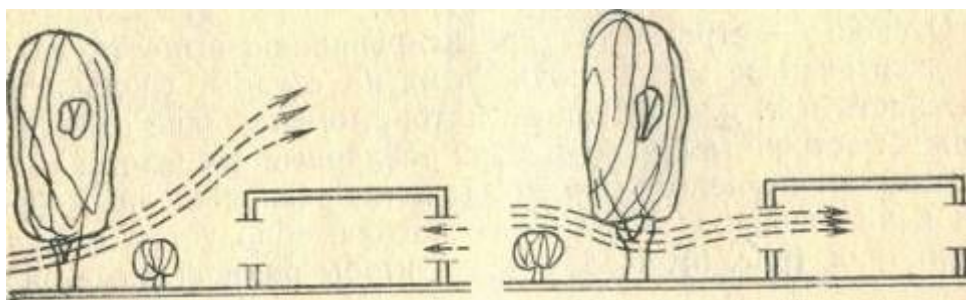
Влияние зеленых насаждений на вентиляцию одноэтажных зданий
